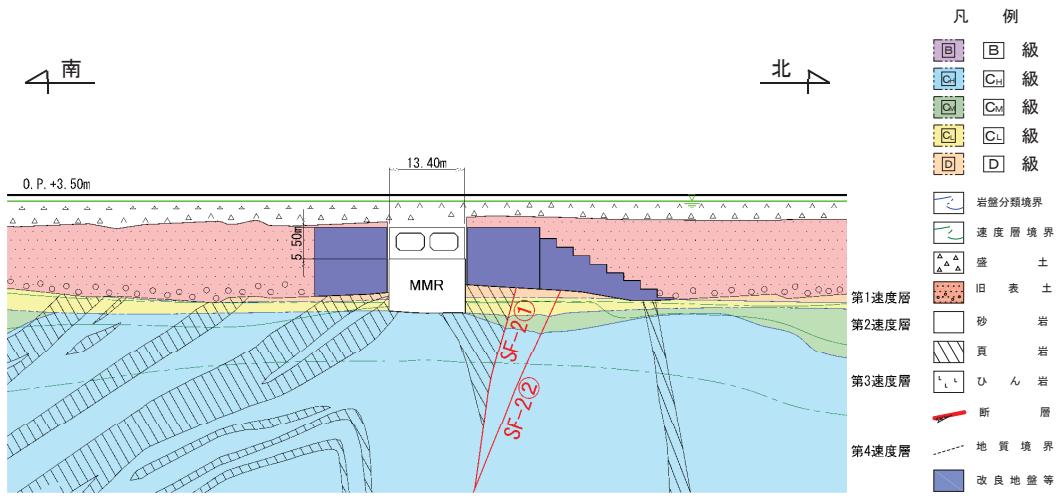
(1) 取水路（標準部） 地震時荷重算出断面図（断面②：直線部）
